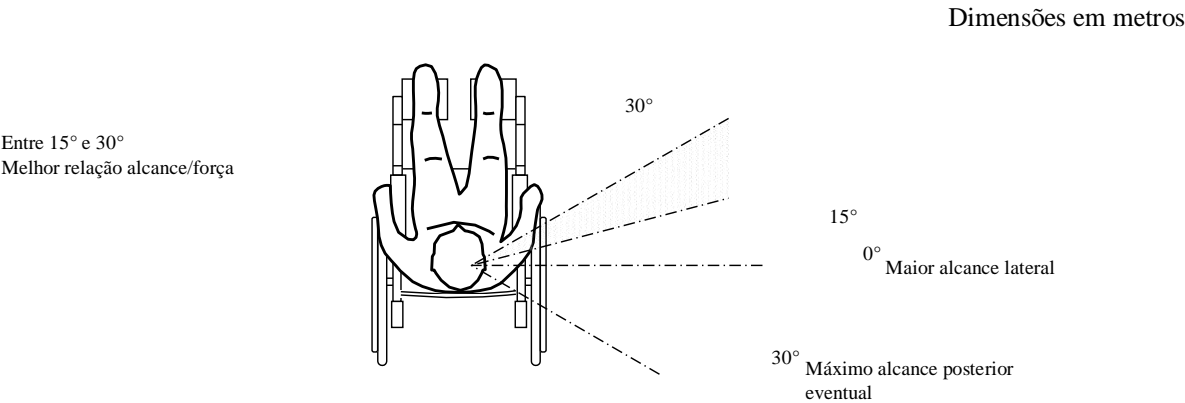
Ângulos para execução de forças de tração e compressão – Plano horizontal
